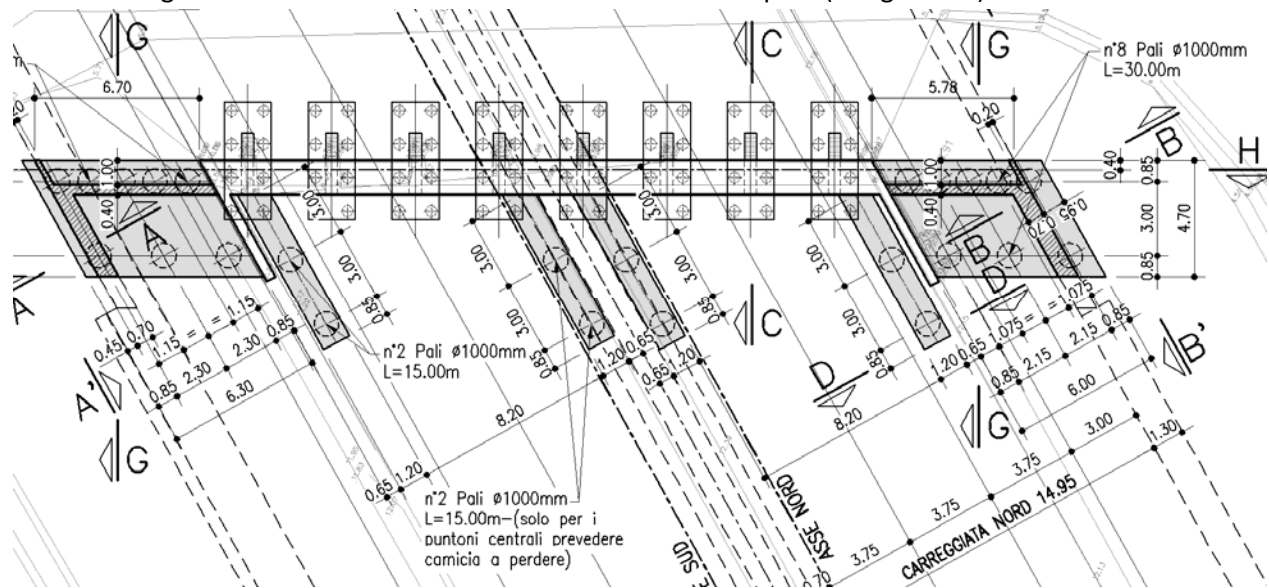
Pianta con localizzazione tiranti a tergo spalla
